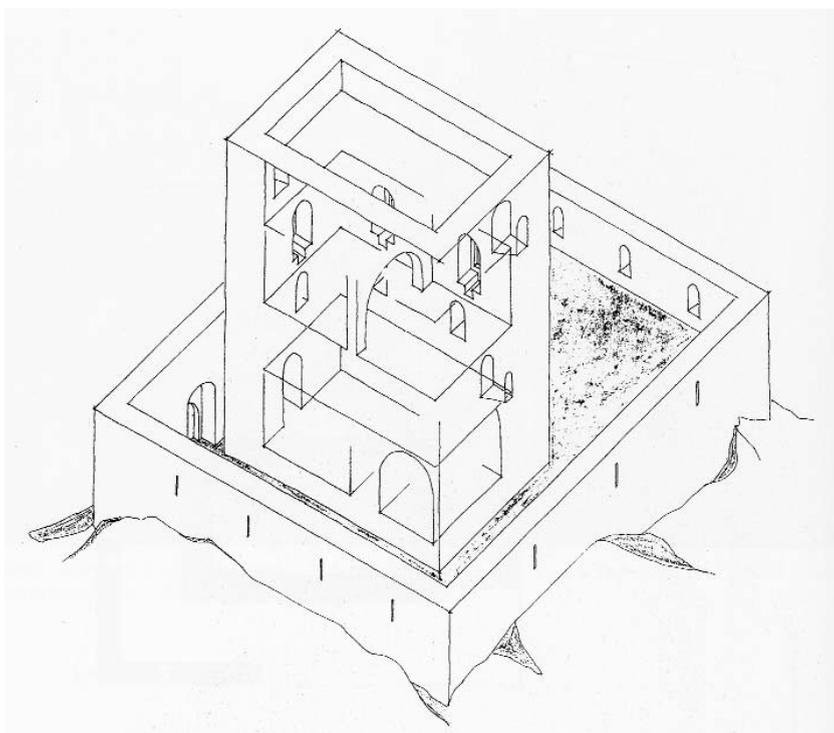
Schema dell'assetto geometrico strutturale della torre di Angelmaro (da C. Filangeri, Presidi di cresta..., tav. VI).
